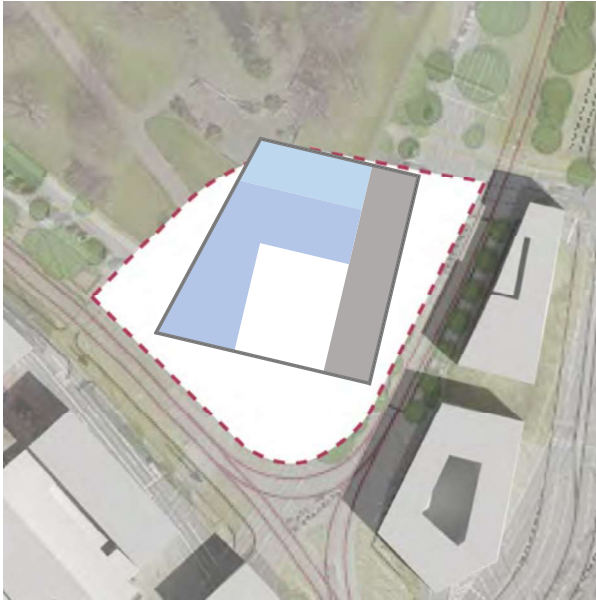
Grundriss UG Bahnhofsquartier V1
